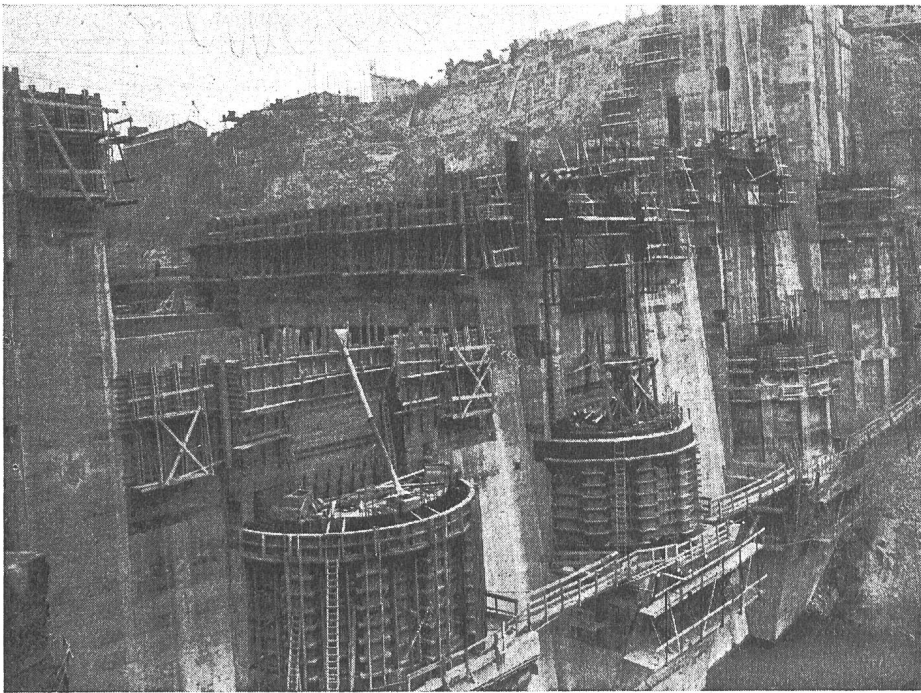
Génissiat. Vue du parement amont du barrage. — Au 1^{er} plan, prises d'eau en construction (21. 12. 1946).
